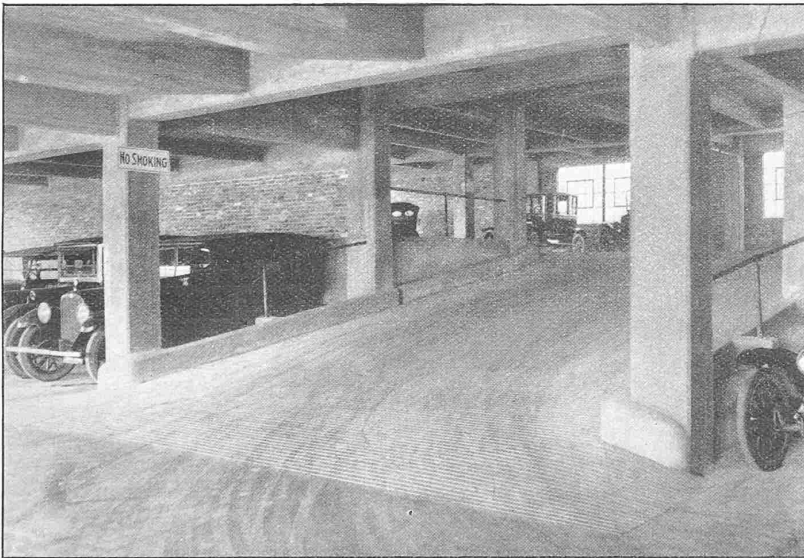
Inneres der Nelson-House-Garage mit d'Humy-Rampen.
